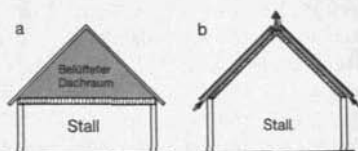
Kaltdach; a) mit ebener Decke, b) mit schräger Decke
